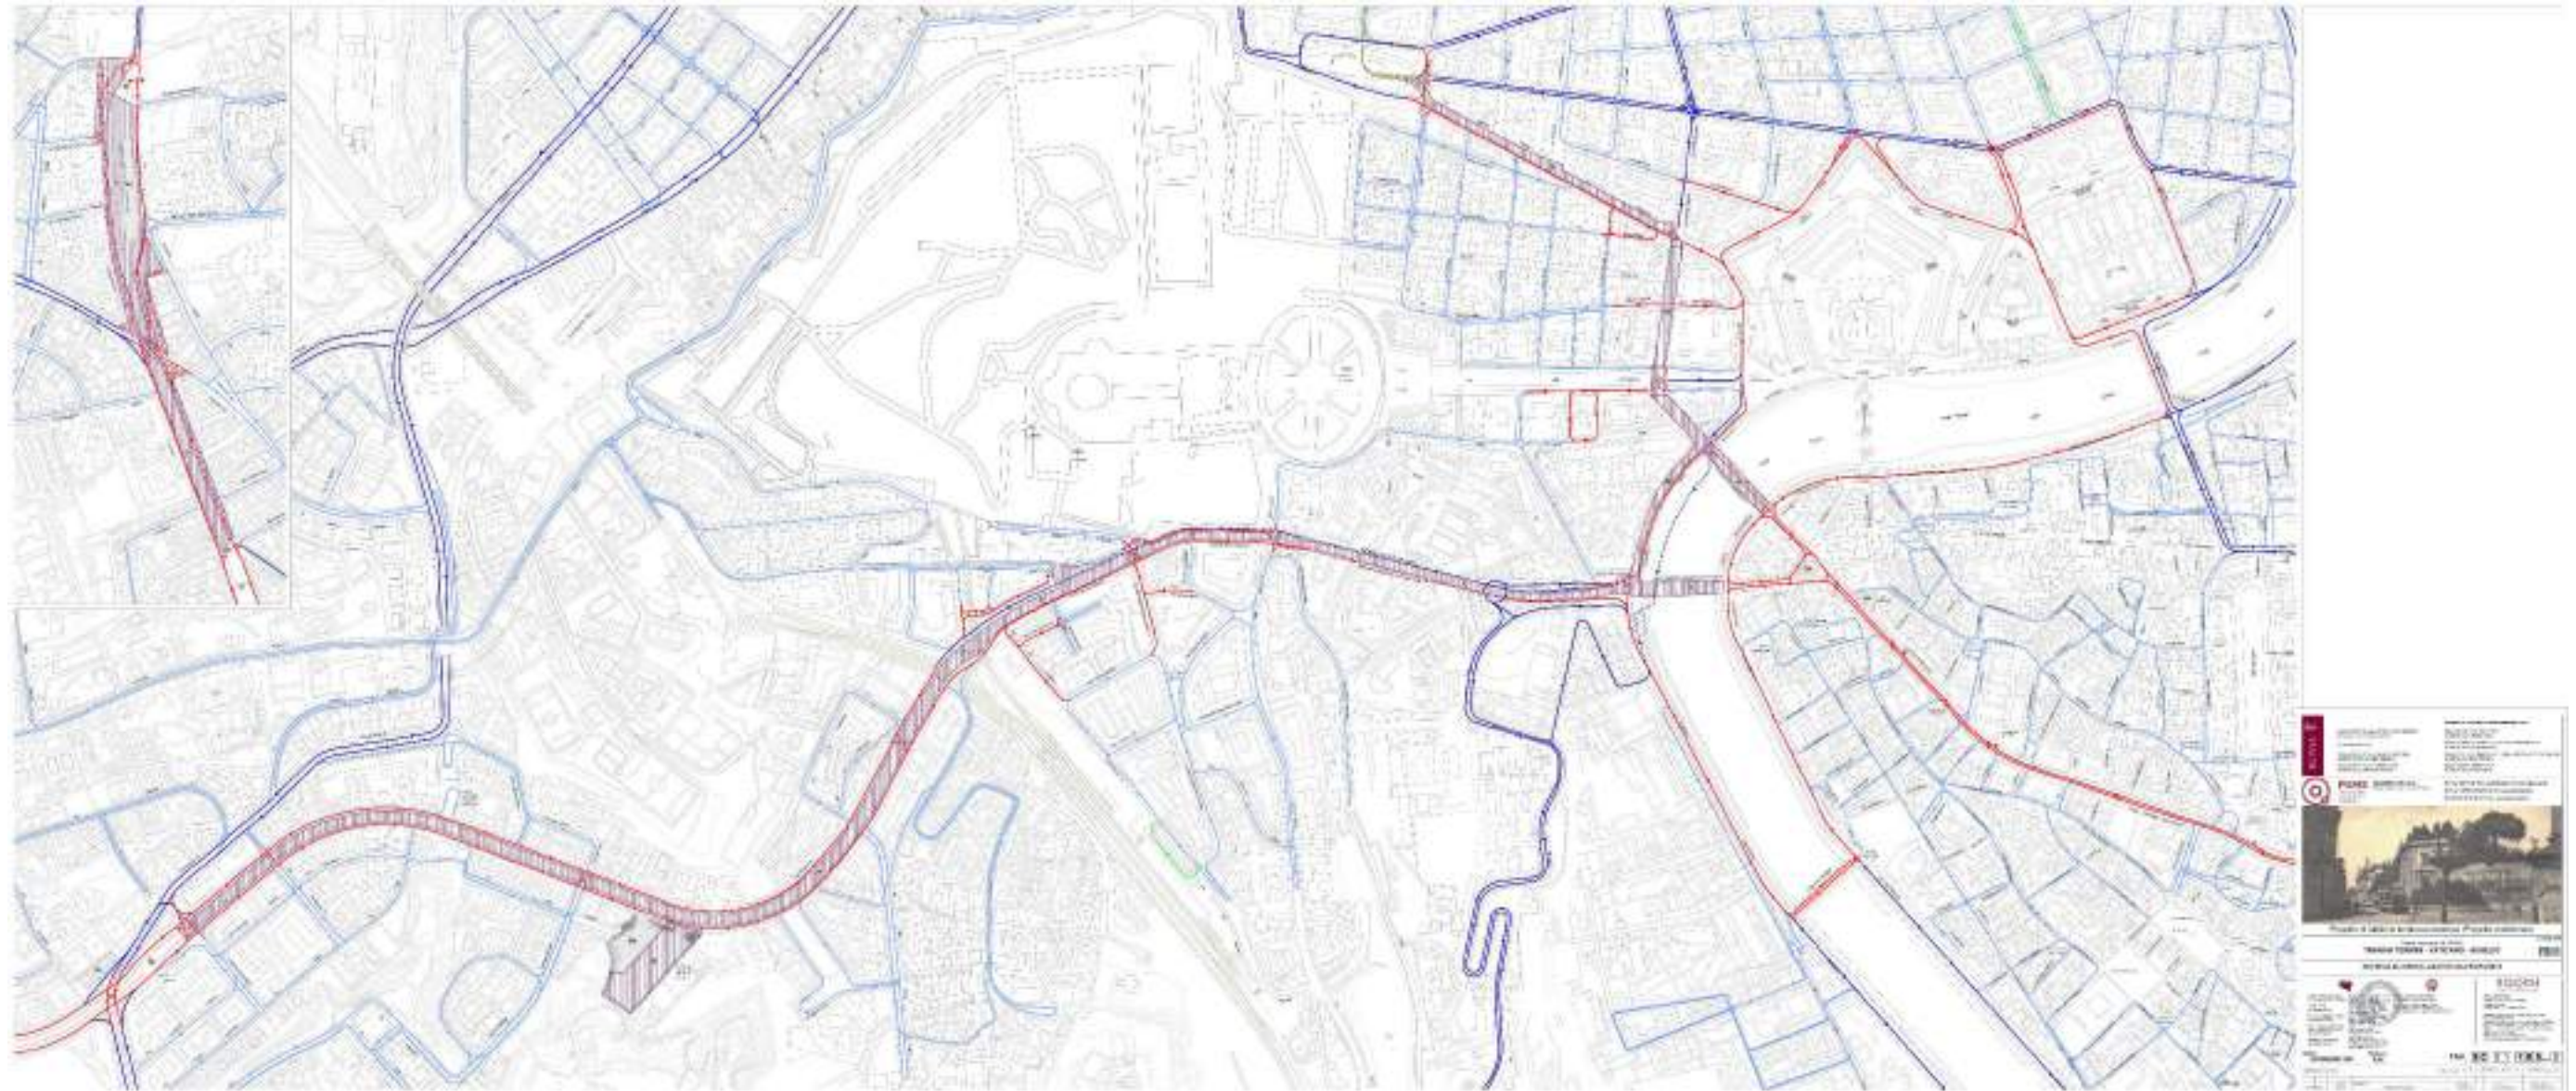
Schema circolazione di cantiere Macrofase 5
